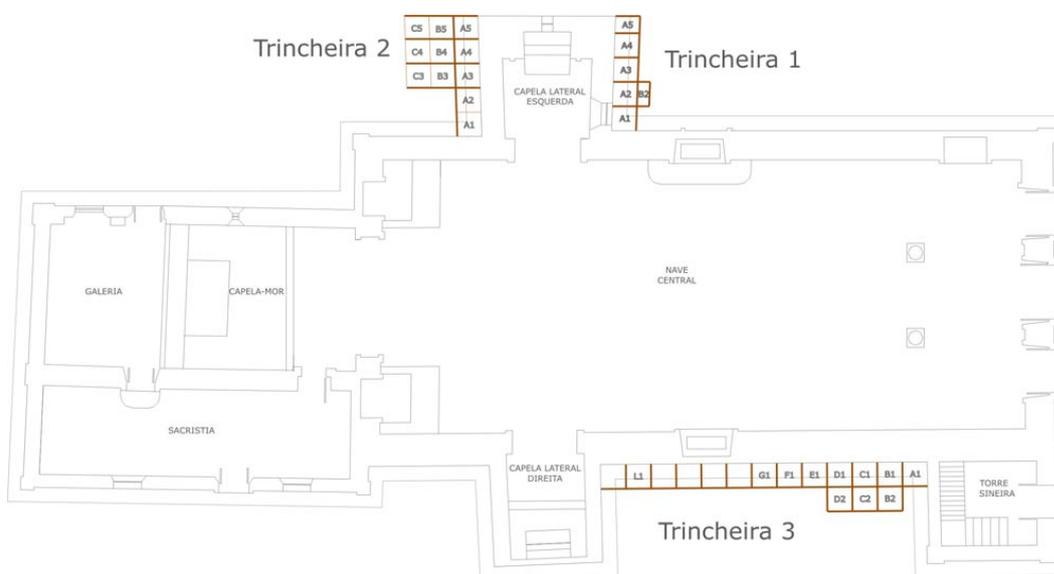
Planta Baixa com as Trincheiras Escavadas.
